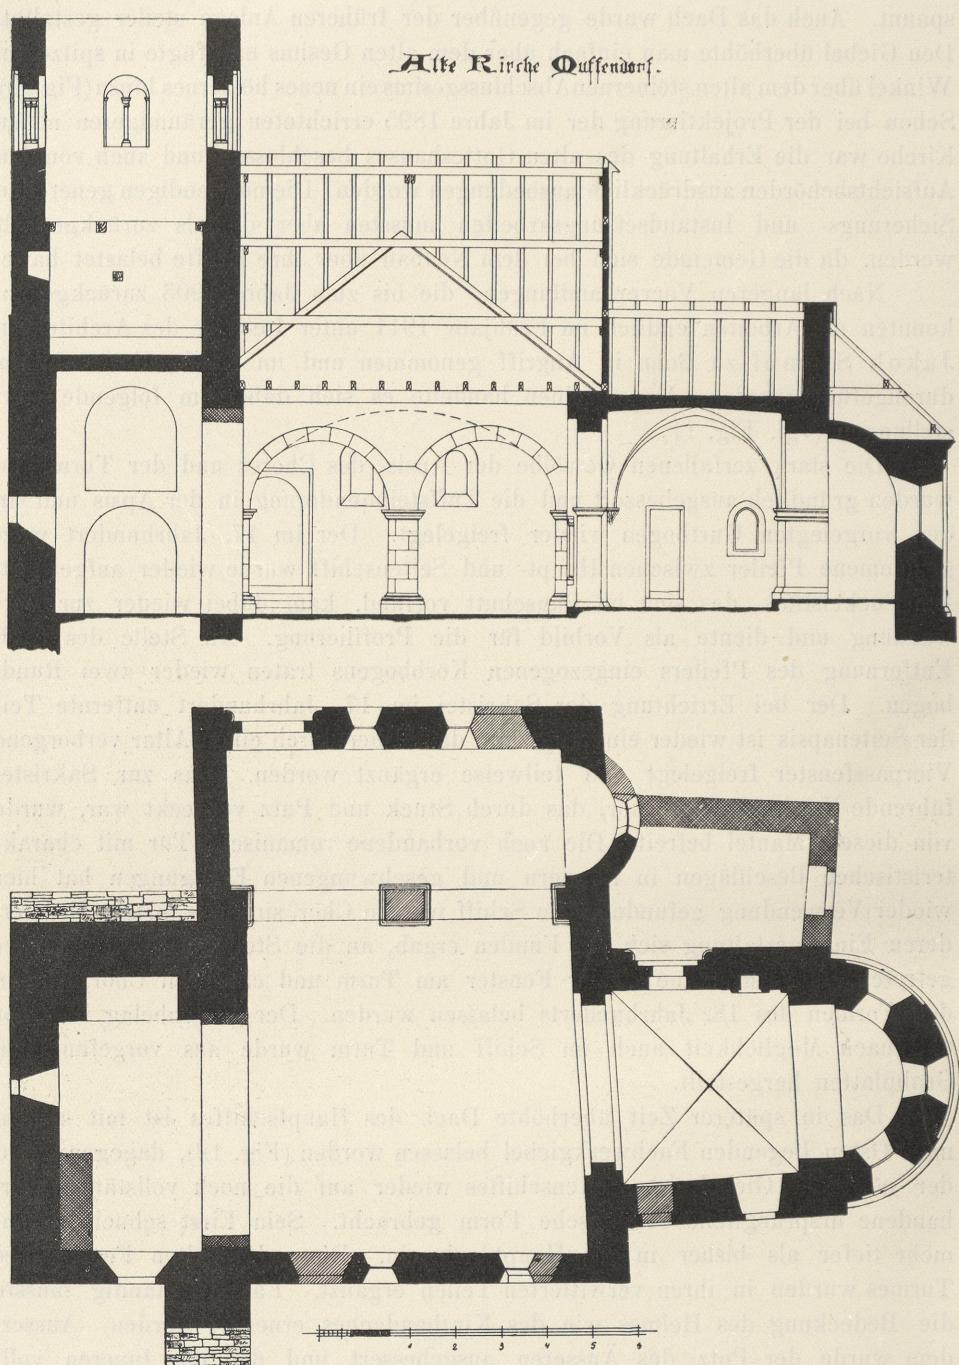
Muffendorf. Alte kath. Kirche. Längenschnitt und Grundriss.
